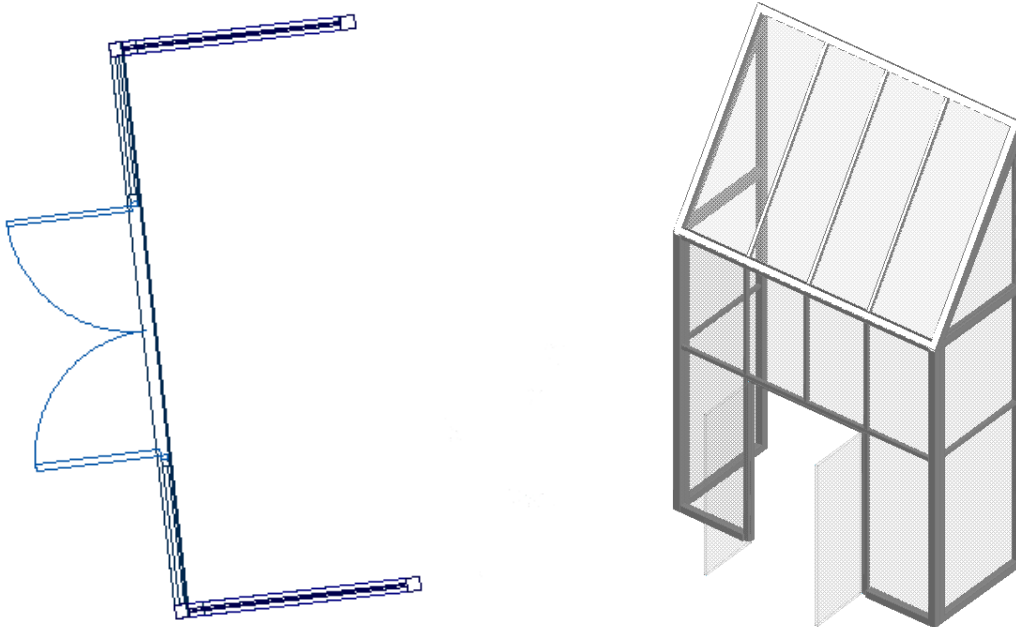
Planta y modelo del elemento del cancel de acceso
